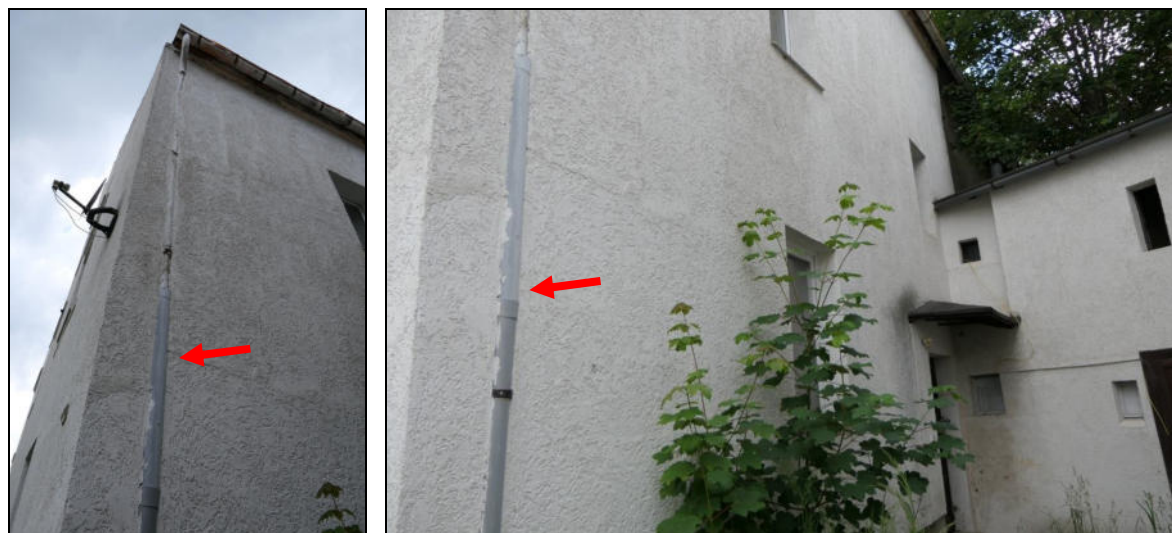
Vordergebäude: Detailansichten (nicht fachmännisch angebrachte Wärmedämmung)
